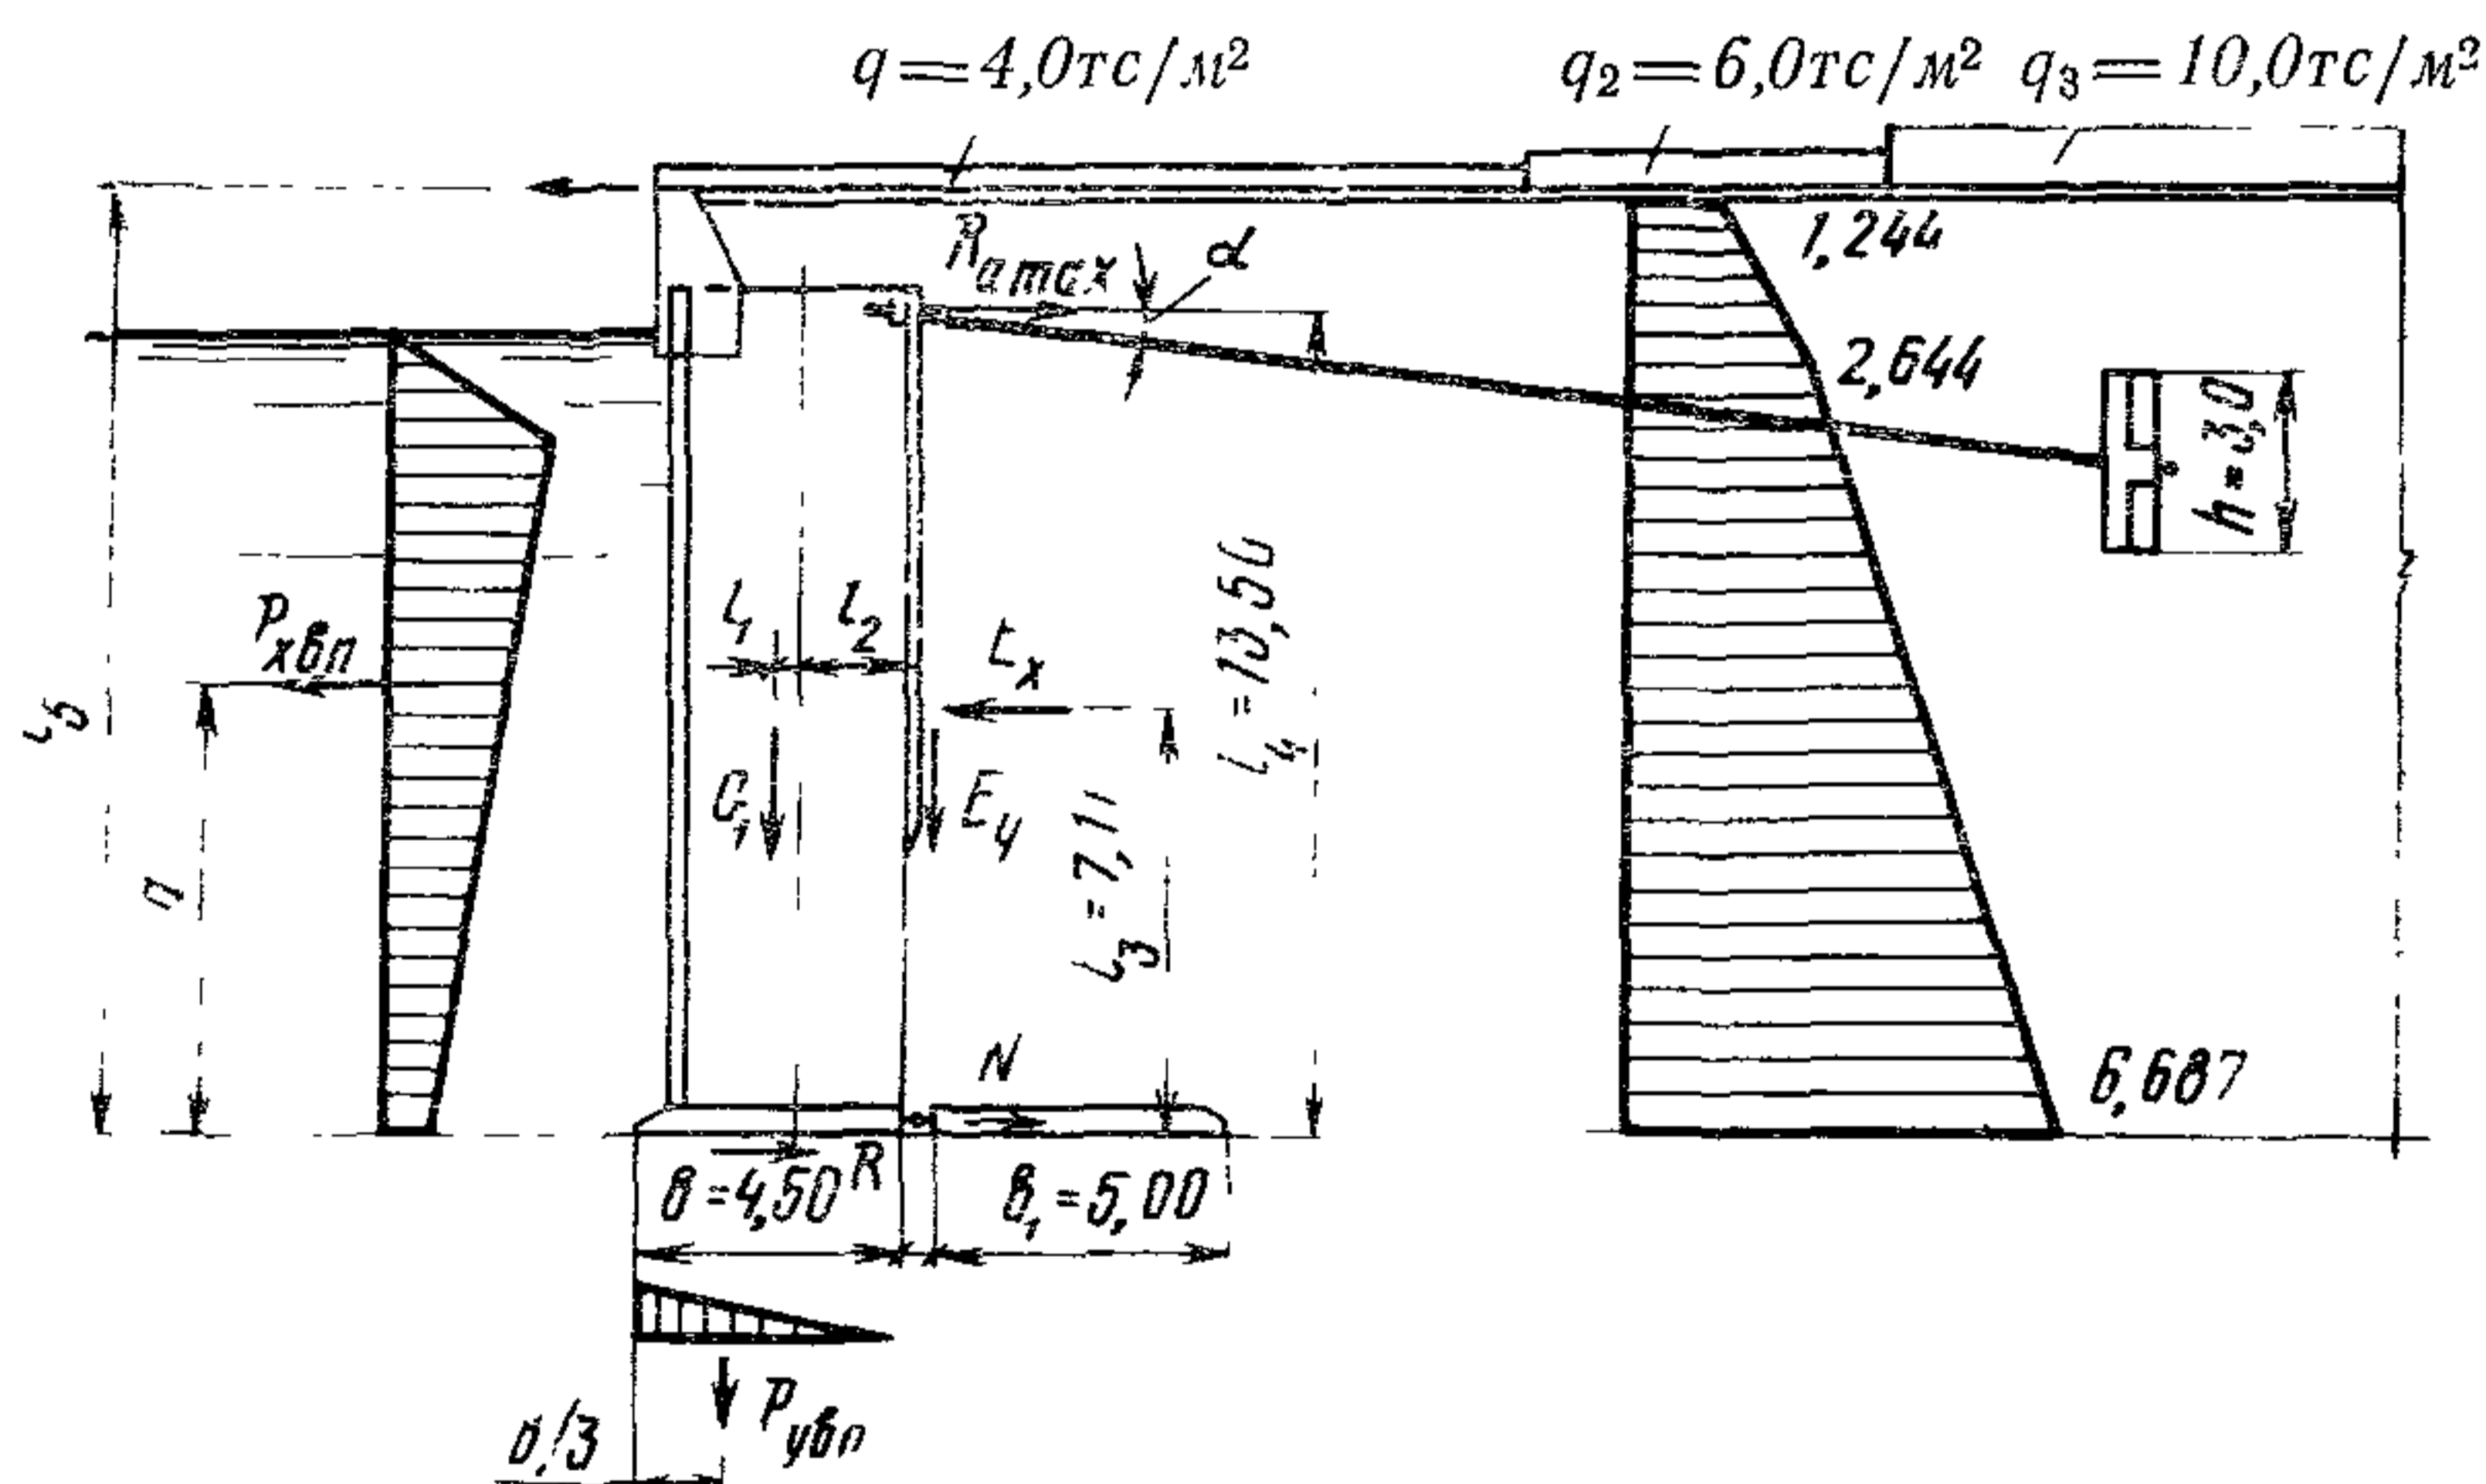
Расчетная схема определения нагрузки от засыпки и временной нагрузки на тыловую грань сооружения
